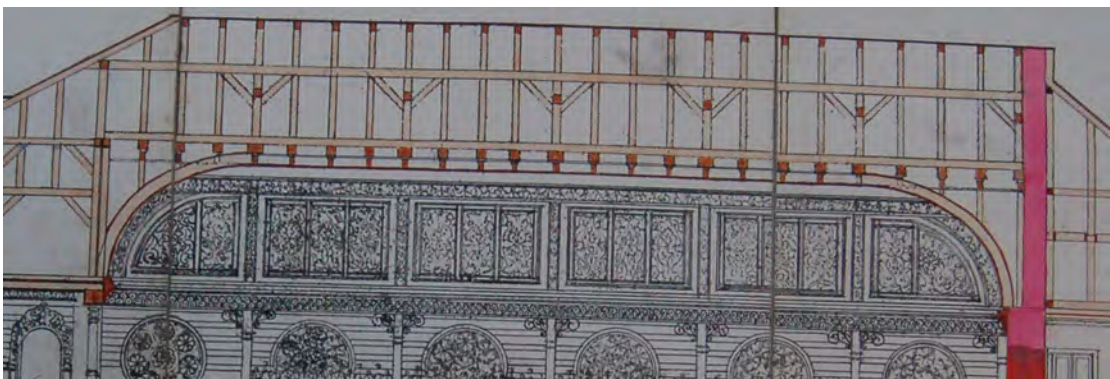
Planmaterial Ausschnitt Längsschnitt
